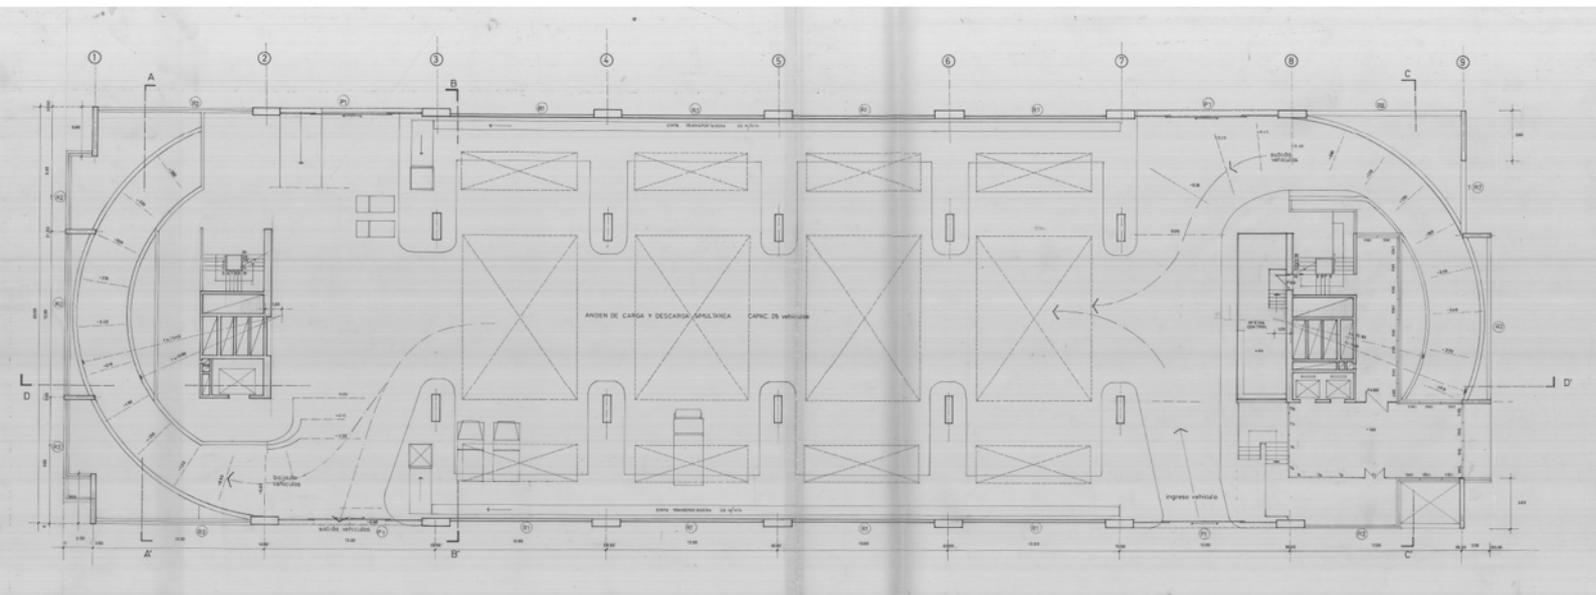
Plano original piso 1. Dirección de arquitectura departamento de proyectos, 1975
